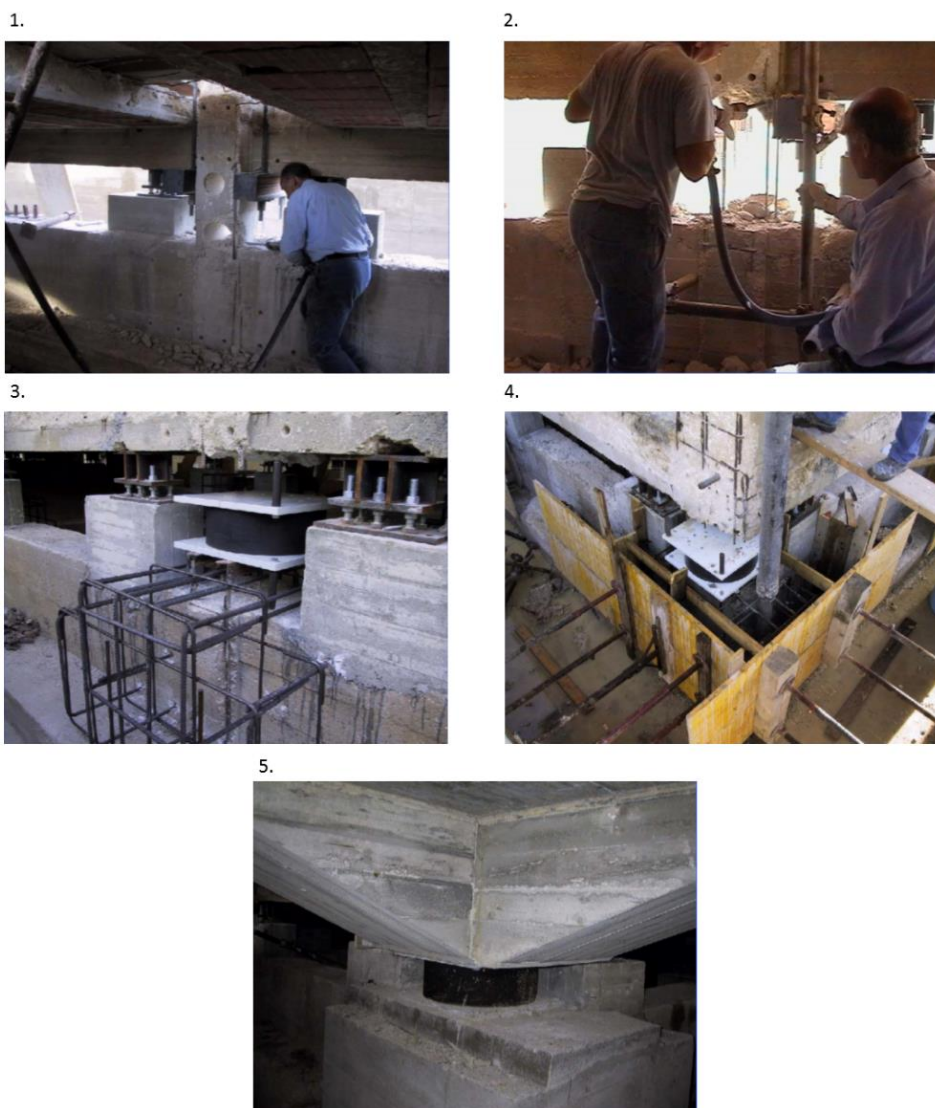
Procedimento de instalação de isoladores em fundações de betão armado (adaptado de Oliveto et al, 2014)
